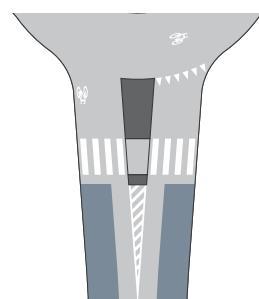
Detailvoorbereeld overgang fietssuggestiestrook naar rotonde met gemengd verkeer
